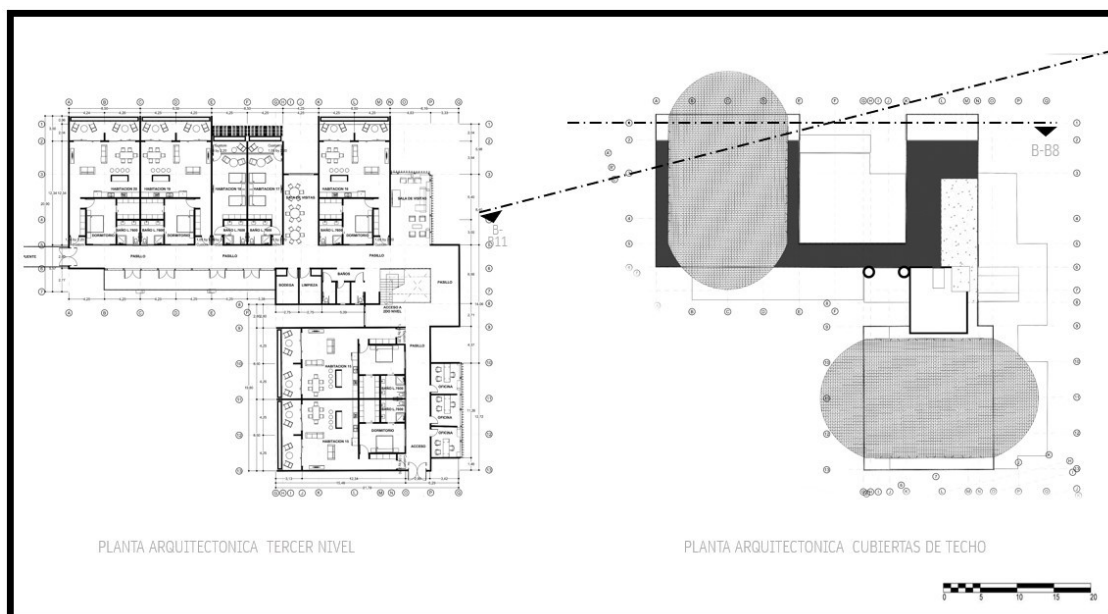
Planta Arquitectónica de cubierta edificio residencial y clínicaNota: Elaboración propia*Figura 78*Planta Arquitectónica primer y segundo nivel, resto edificio residencial y clínicaNota: Elaboración propia
